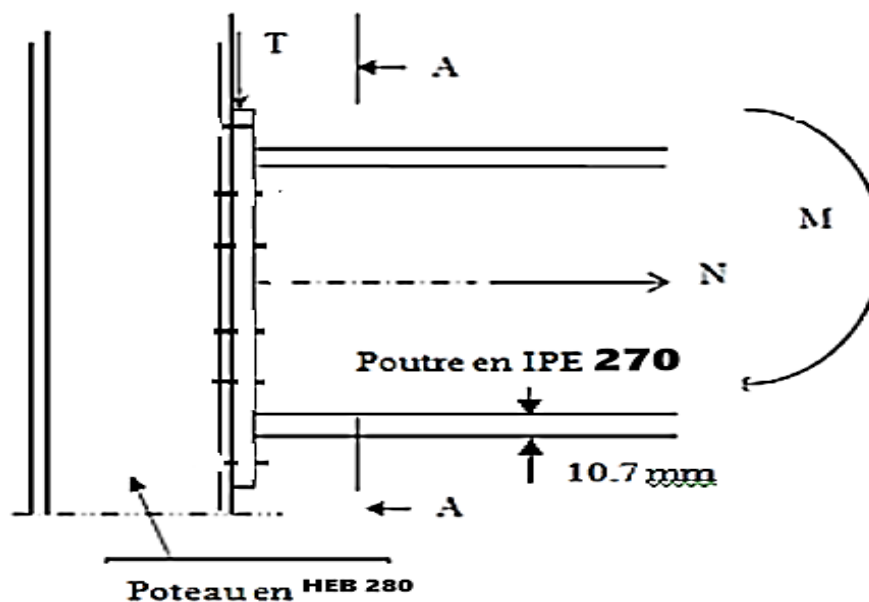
Détail de l'assemblage poteau-poutre de la structure étudiée
